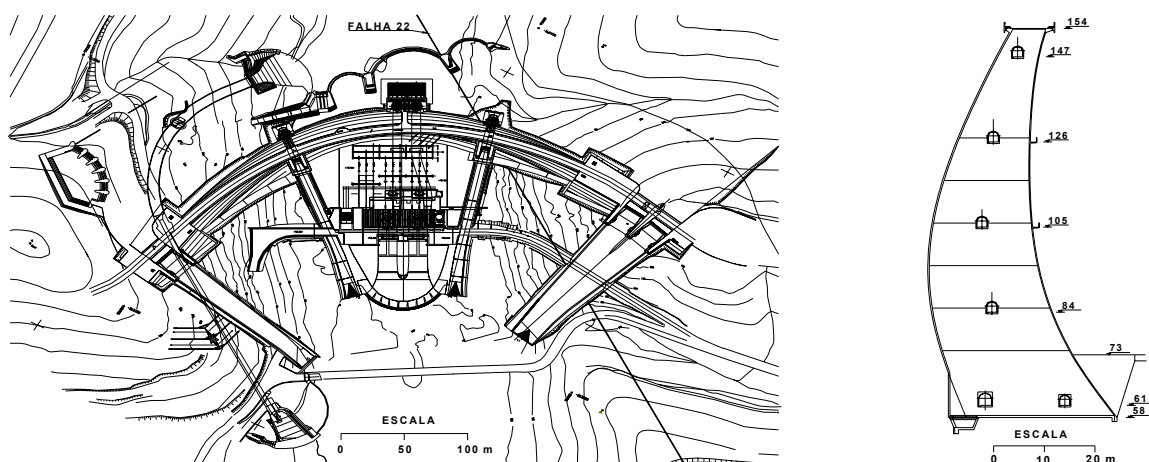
Planta e consola central da barragem de Alqueva
